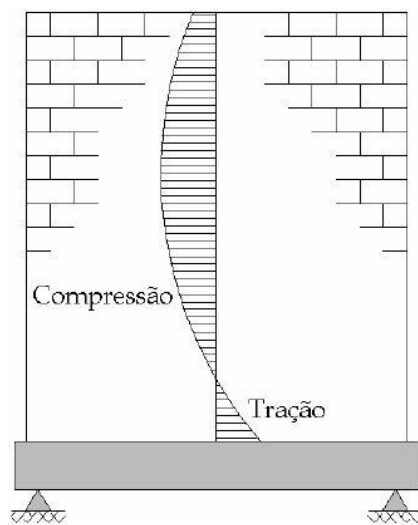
Tensões horizontais no sistema parede-viga (SILVA, 2005)
